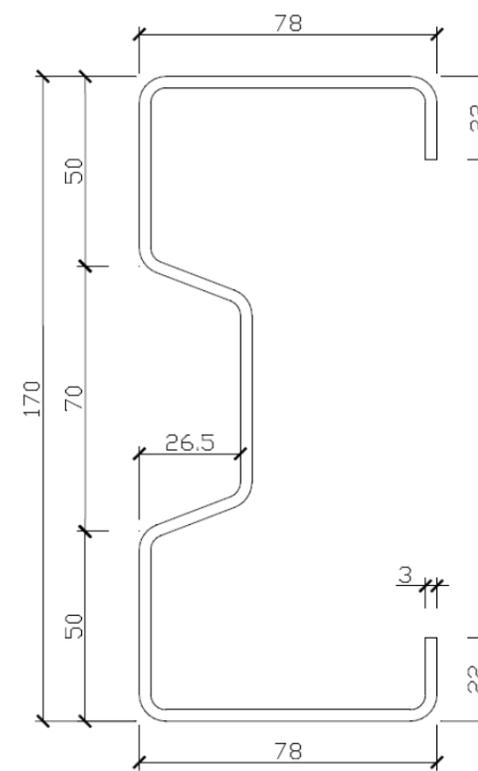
Schéma en coupe de pieux « creux » (Source : Corfu Solaire)
